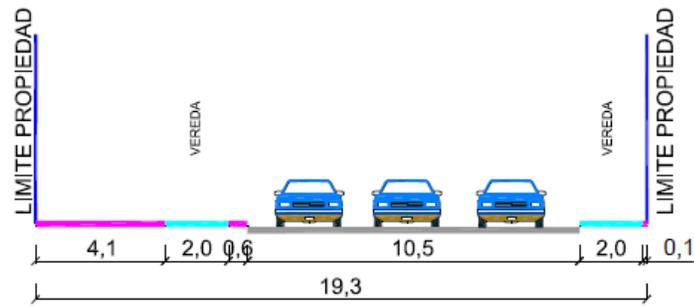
Perfil Tipo Av. San Martín, Andes – Santa Teresa
